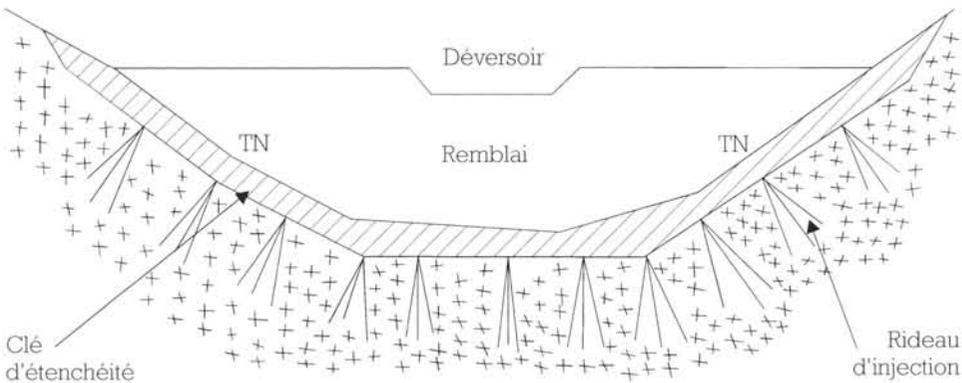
Schéma d'injection d'une fondation rocheuse (vue face aval).
